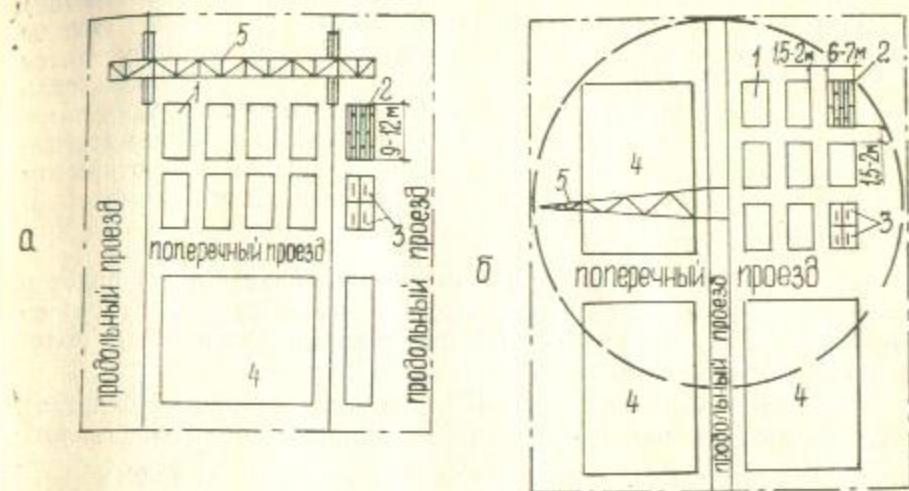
Схемы размещения штабелей и пакетов на открытом складе при укладке козловым (а) и башенным (б) кранами:
